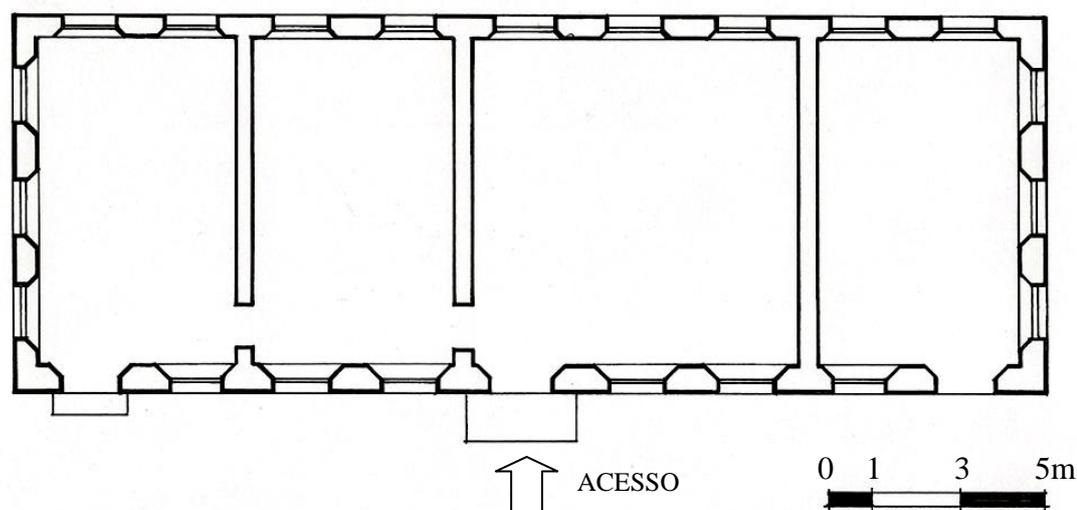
Planta Baixa esquemática do primeiro Grupo Escolar de Baturité na praça Waldemar Falcão
